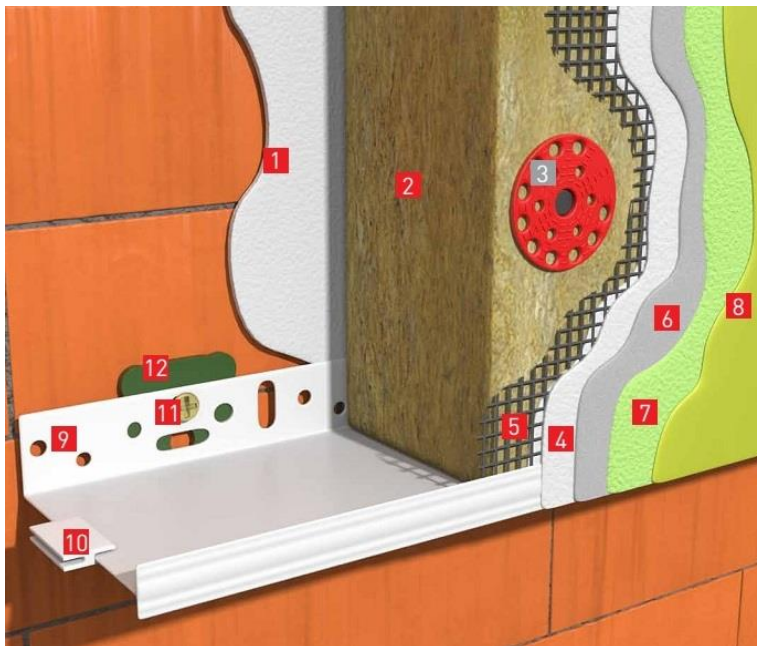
Конструкція фасадної системи утеплення зовнішніх стін з облицюванням тонкошаровою штукатуркою: 1 – клейовий шар; 2 – теплоізоляційні плити; 3 – фасадний дюбель; 4 – гідрозахисний шар (спеціальна шпаклівка або клей); 5 – скловолоконна армувальна сітка; 6 – ґрунтовочний шар; 7 – декоративна мінеральна штукатурка; 8 – фасадна силіконова фарба; 9 – цокольний профіль; 10 – елемент стикування; 11 – цокольний дюбель; 12 – компенсатор нерівності.
